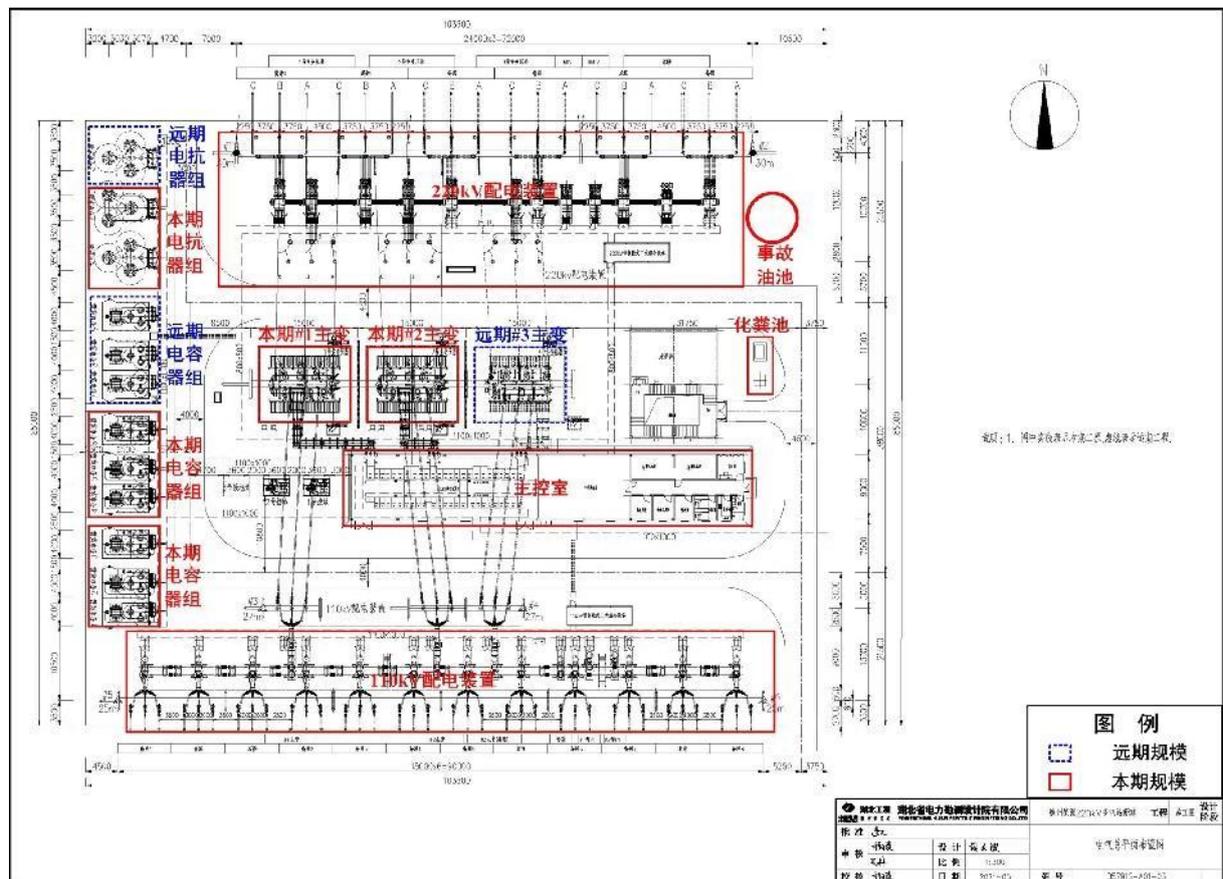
梨园（岁丰）220kV 变电站总平面布置图
